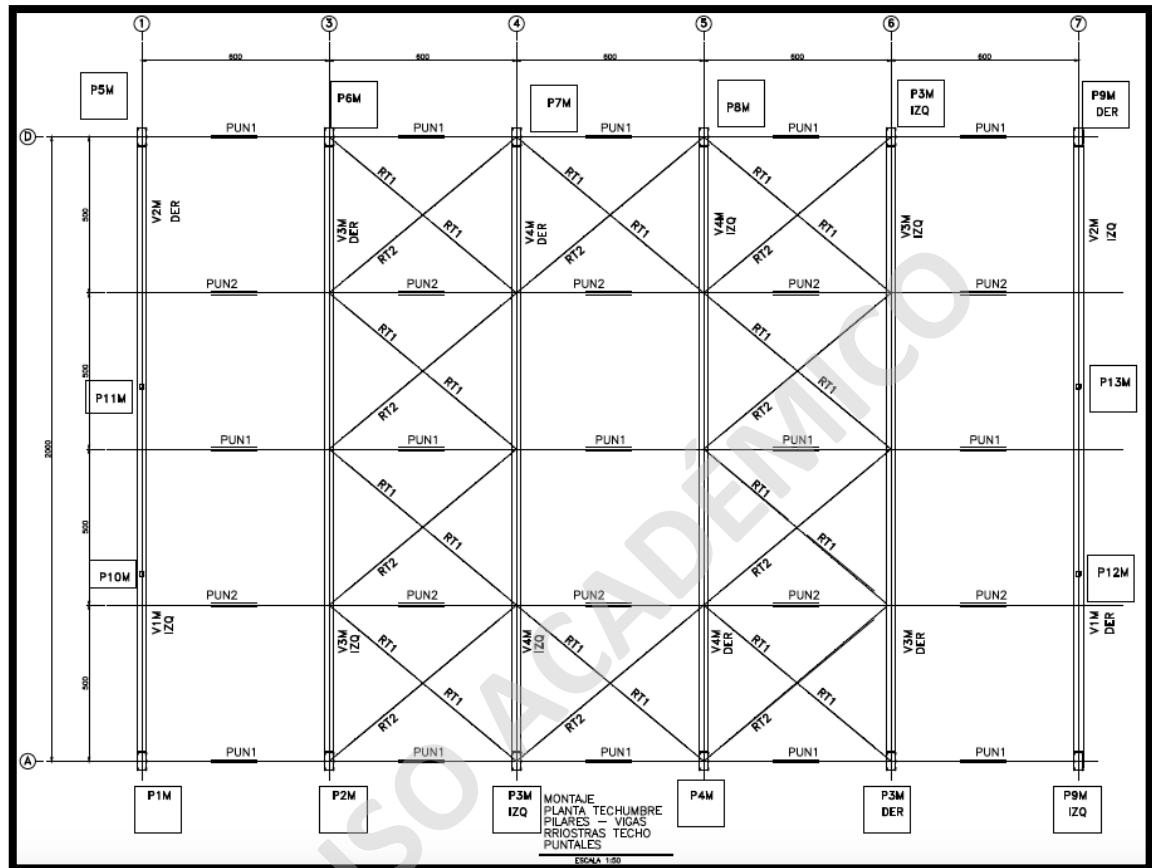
Planta de Montaje de Pilares y Vigas ODR Ingeniería y Montajes
